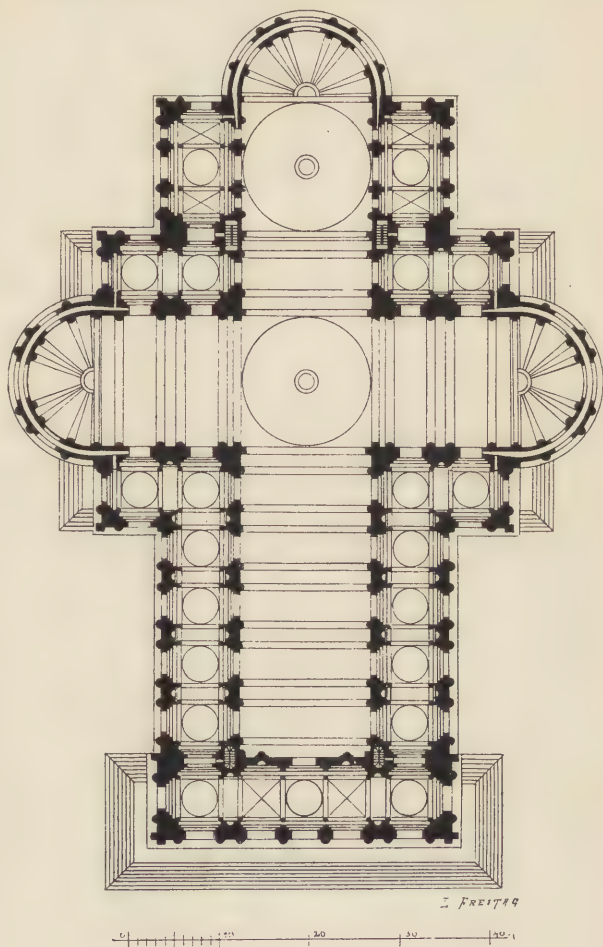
Grundriss Scamozzi's für den Dom zu Salzburg.
